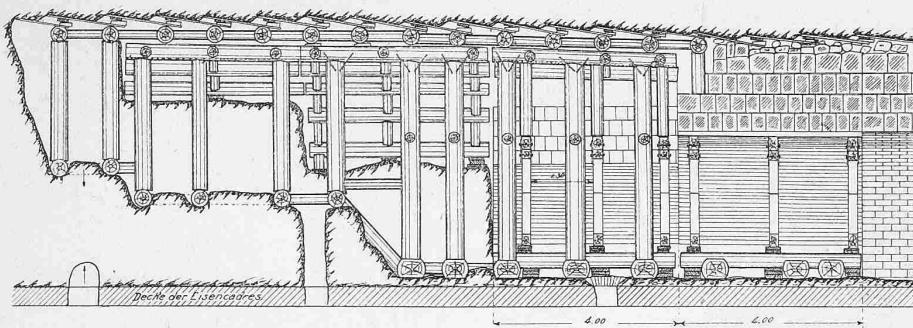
Längsschnitt durch Gewölbe-Rüstung und Mauerung — Masstab 1:150.
